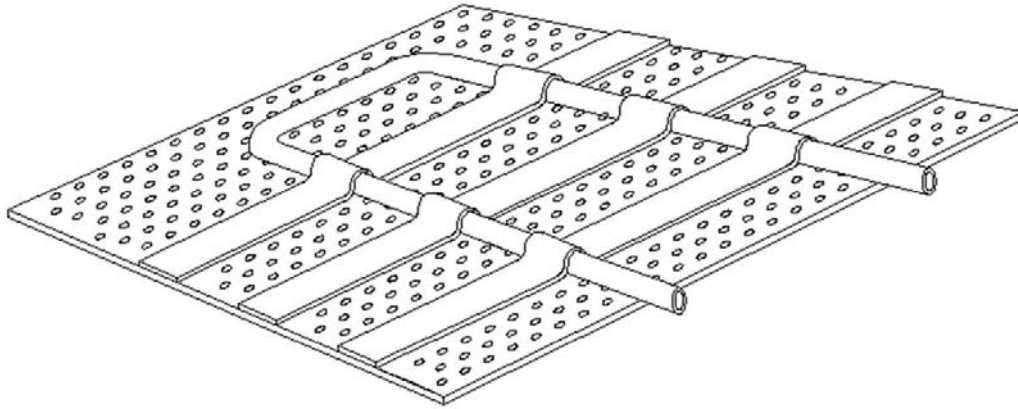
Vue d'ensemble tube et ailettes sur le bac
